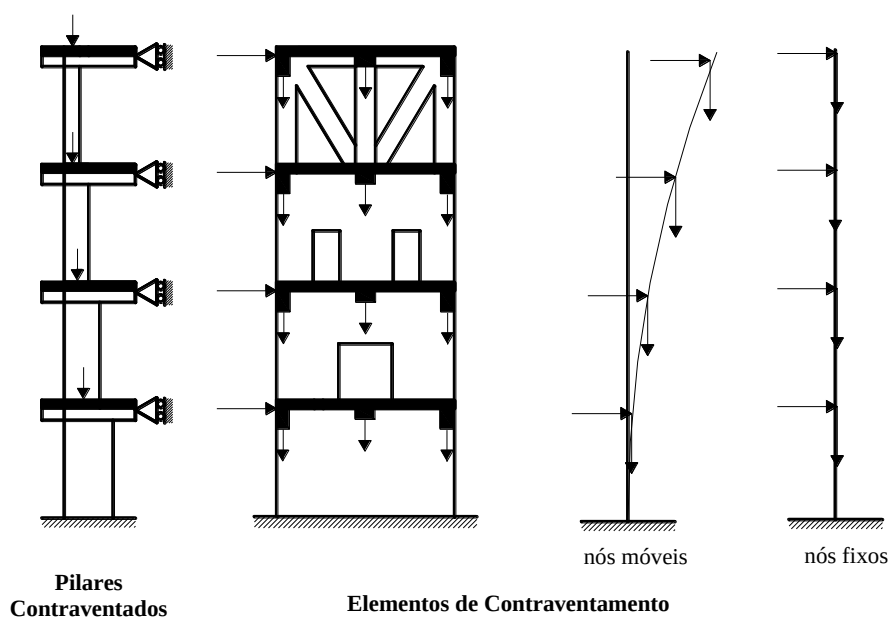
Pilares contraventados e elementos de contraventamento (FUSCO, 1981).
